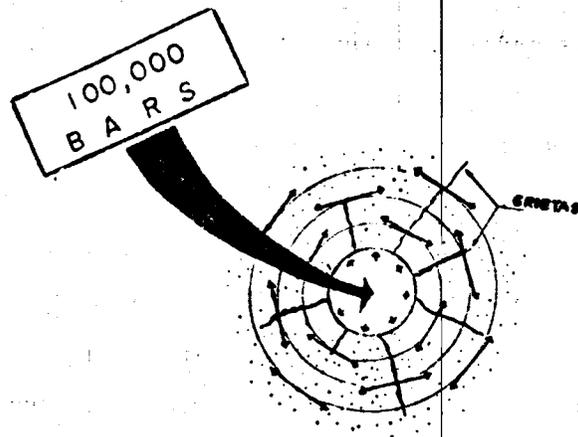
La roca alrededor de un barreno con gases a presión -- (del explosivo) está sometida a tensión. Si la presión es suficientemente grande también lo será la tensión y habrá grietas.
